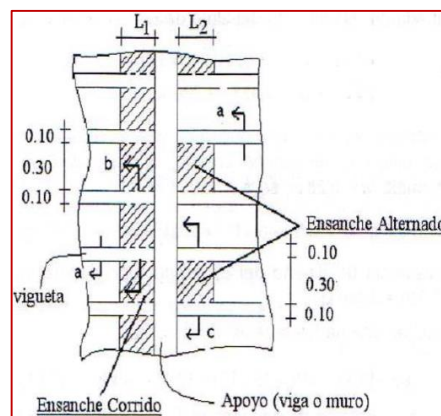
Ensanche Corrido y Alternado de Vigüeta
